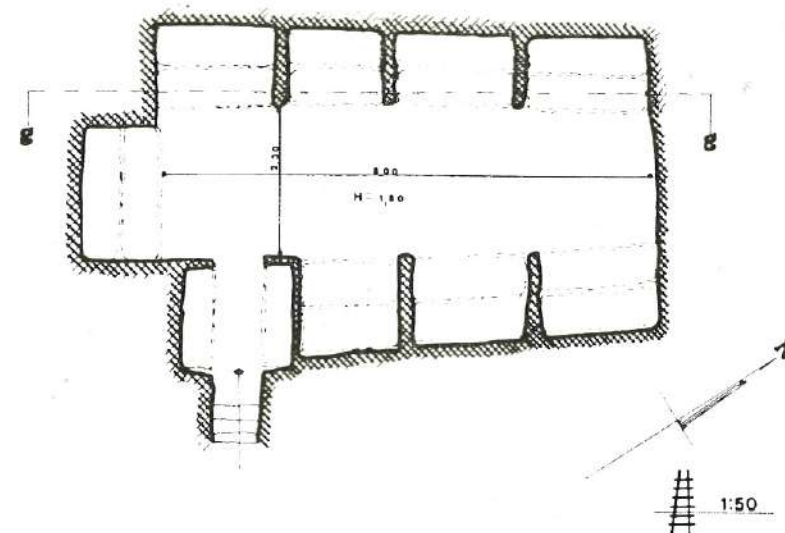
SCOPPA: planimetria dell'ipogeo n. 2.
